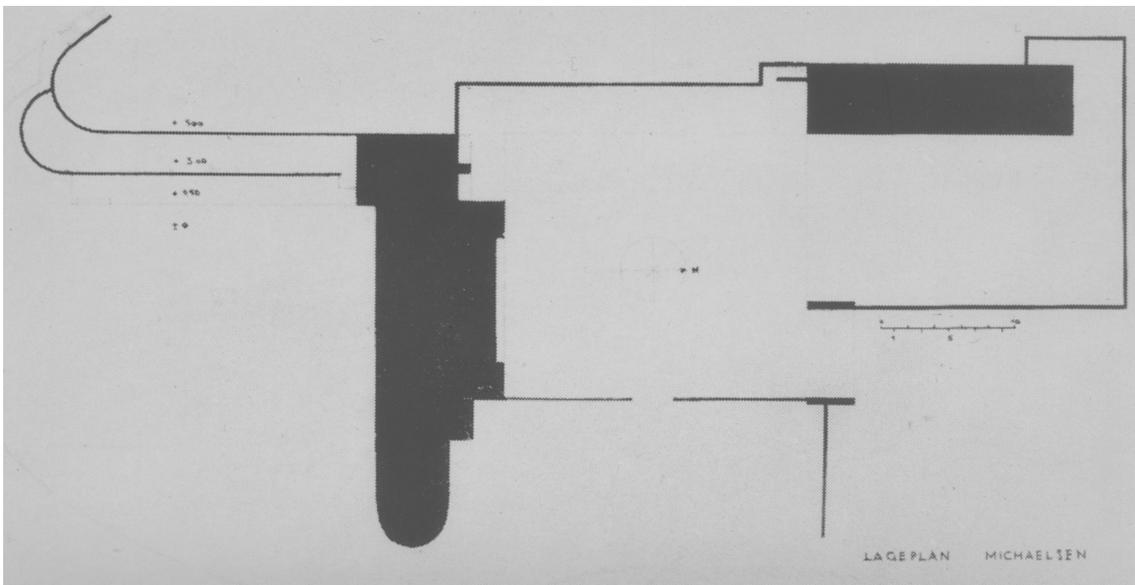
Lageplan (Publikationsplan), ohne Datum (Ende 1923)
